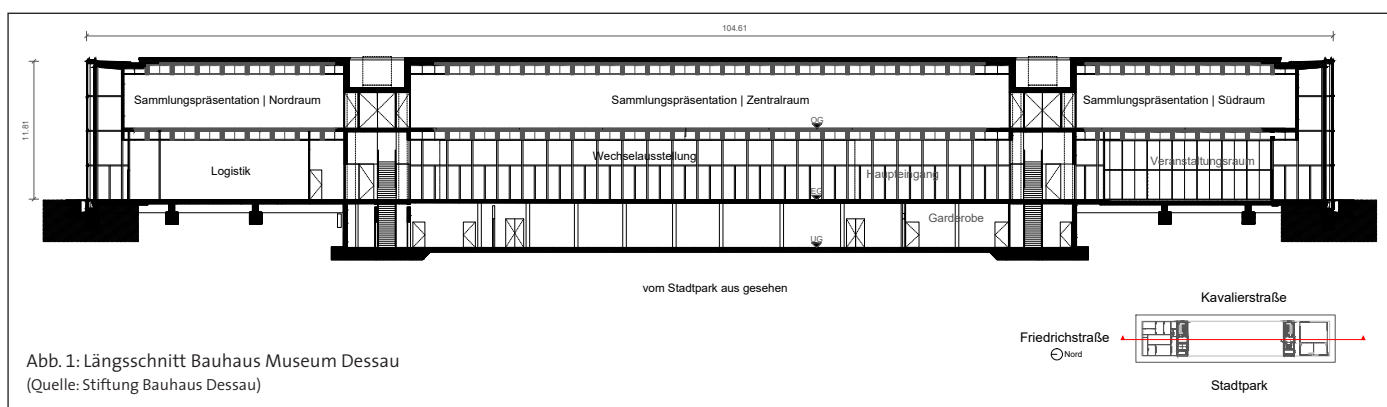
Längsschnitt Bauhaus Museum Dessau (Quelle: Stiftung Bauhaus Dessau)
